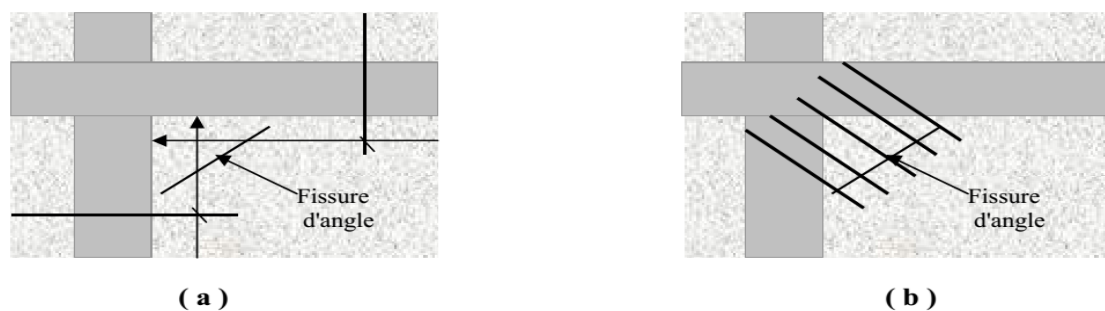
Fissuration à 45° d'une dalle ; dispositions préventives du ferrailage: (a) : croisement des chapeaux.(b) : armatures en renfort
